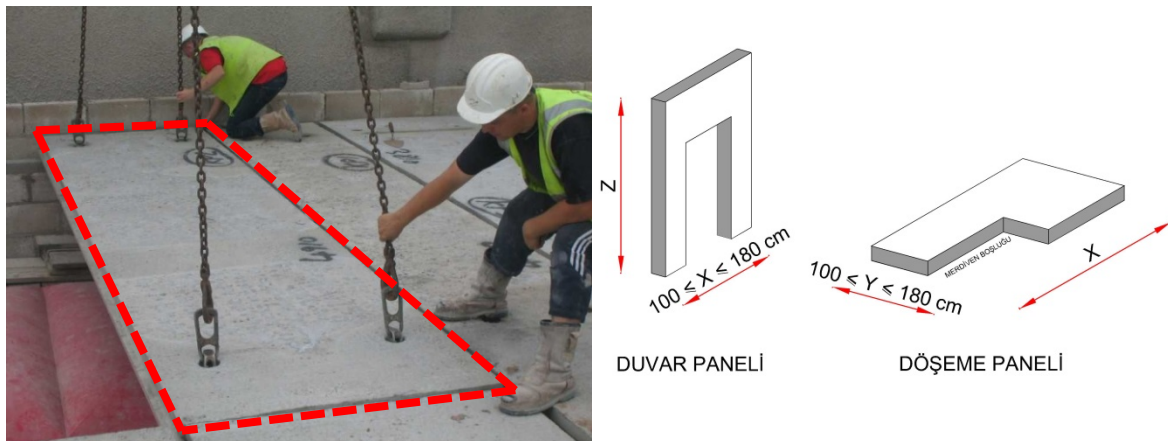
Prefabrike büyük boy beton paneller ve örnek bir uygulama (URL-1)
